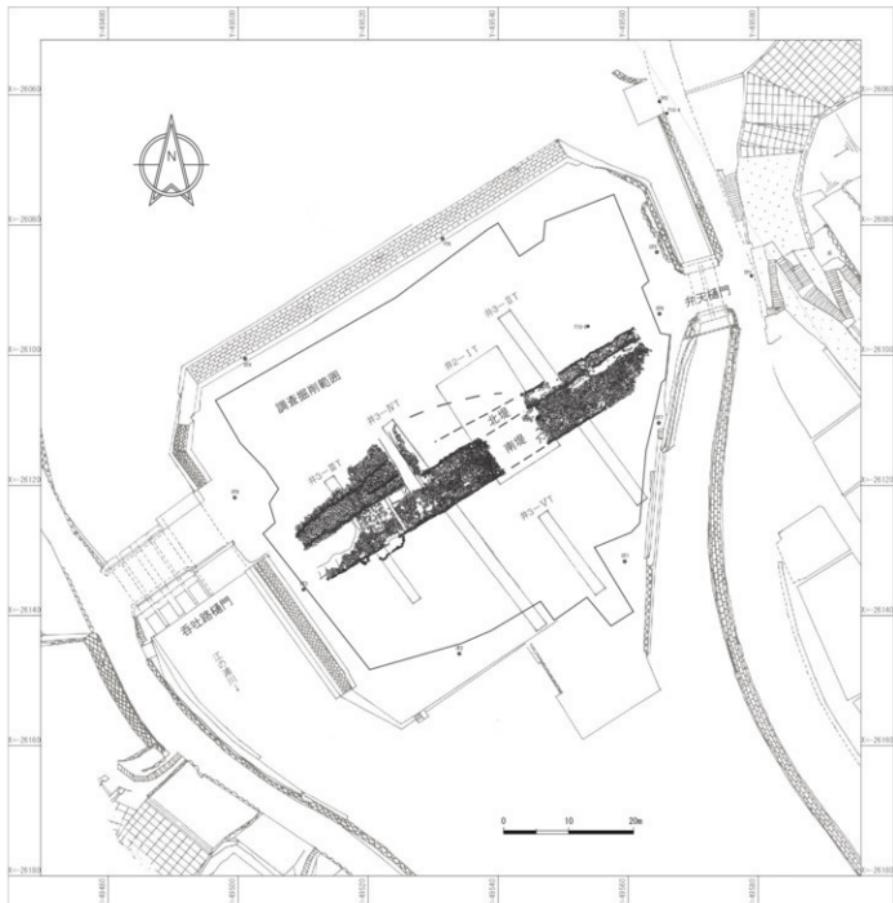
井樋堤跡全体平面図 (S=1/750) 範囲確認調査のトレンチ配置図と今回調査の平面図を合成
